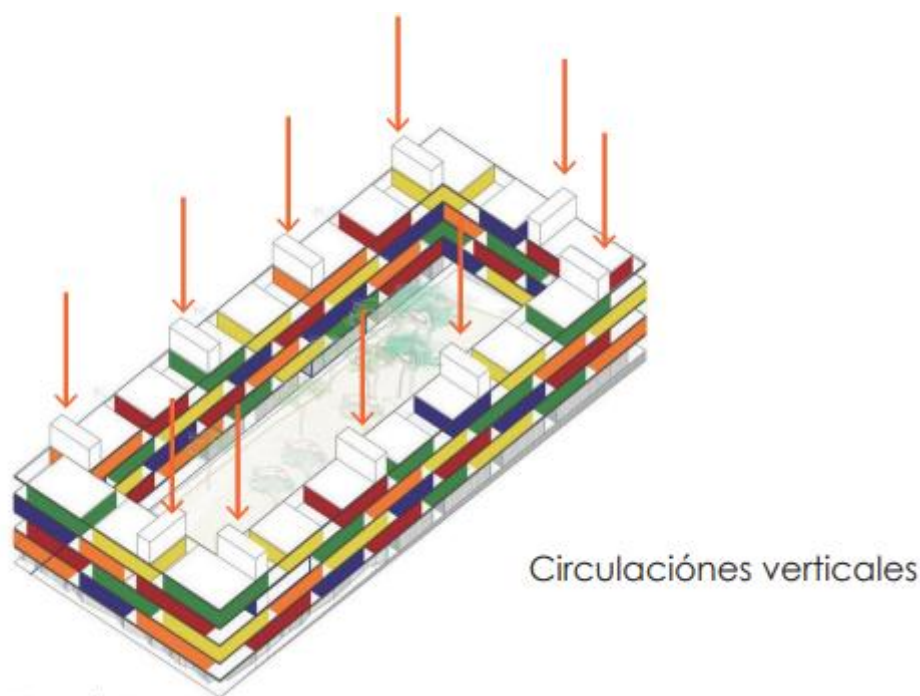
Esquema de agrupación de viviendas. Adaptado de Plataforma Arquitectura (<https://www.plataformaarquitectura.cl>)
